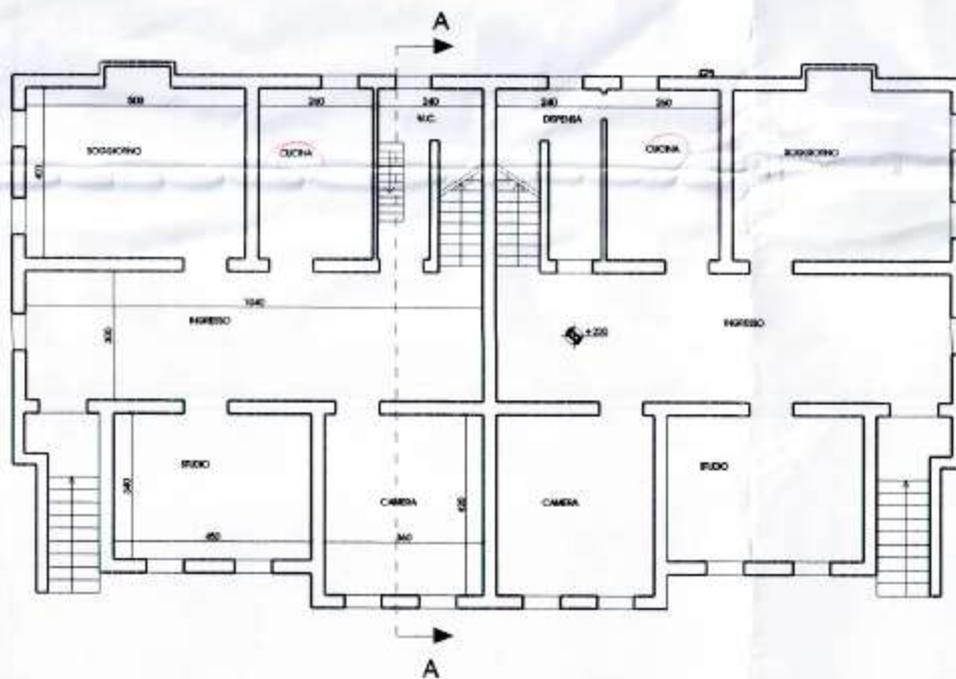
Planimetria Piano Terra e Primo del Fabbricato Pre esistente
